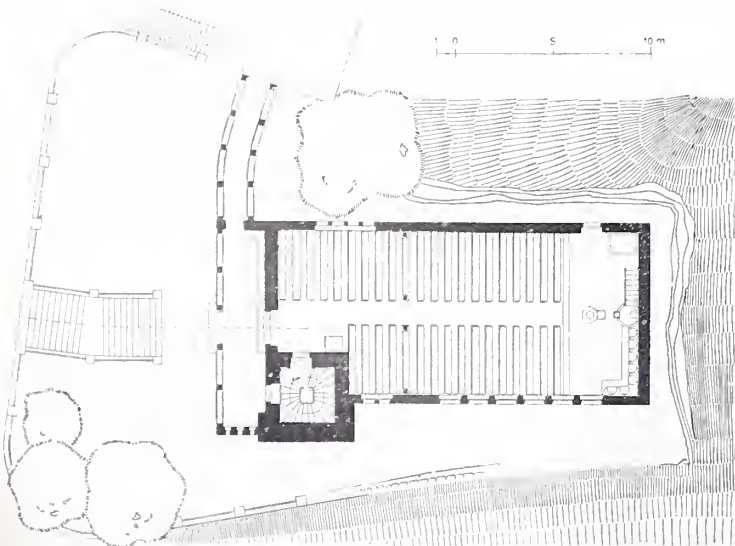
Grundriss der Kirche. — Masstab 1:400.
